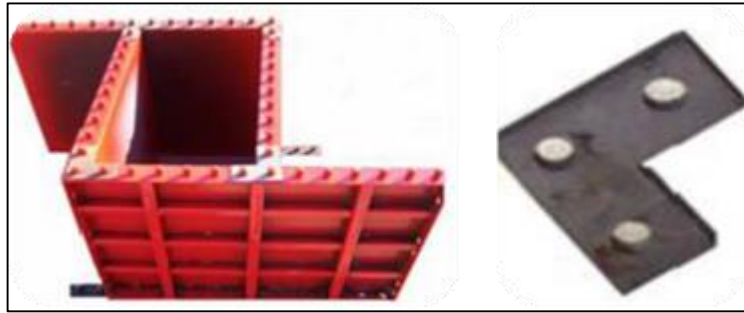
Escuadra de cierre para elementos de los encofrados
